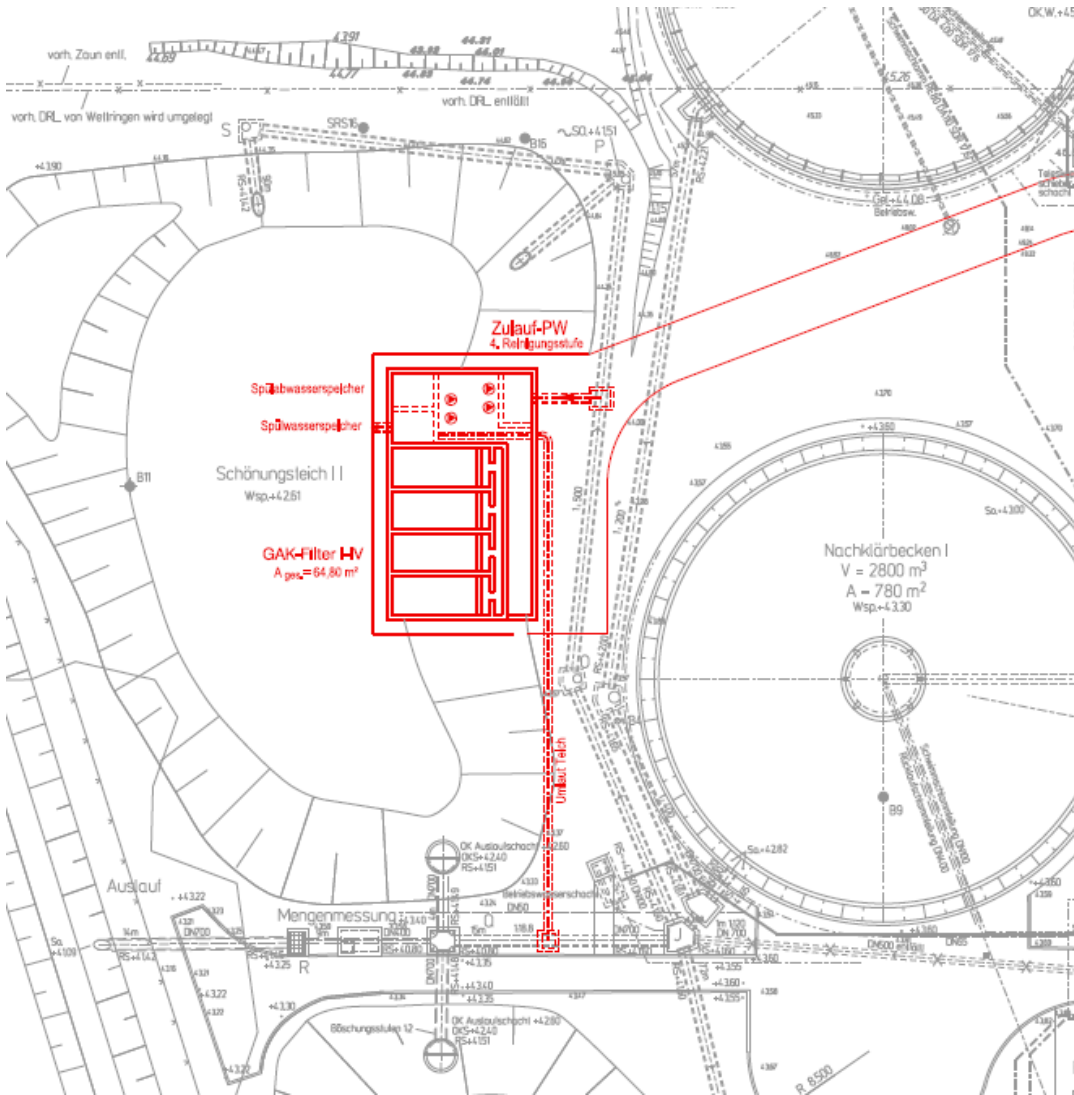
Lageplanausschnitt Variante 2: GAK-Filtration
